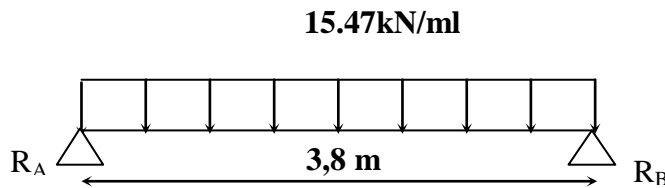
Schéma statique de la poutre de chaînage à l'ELU
